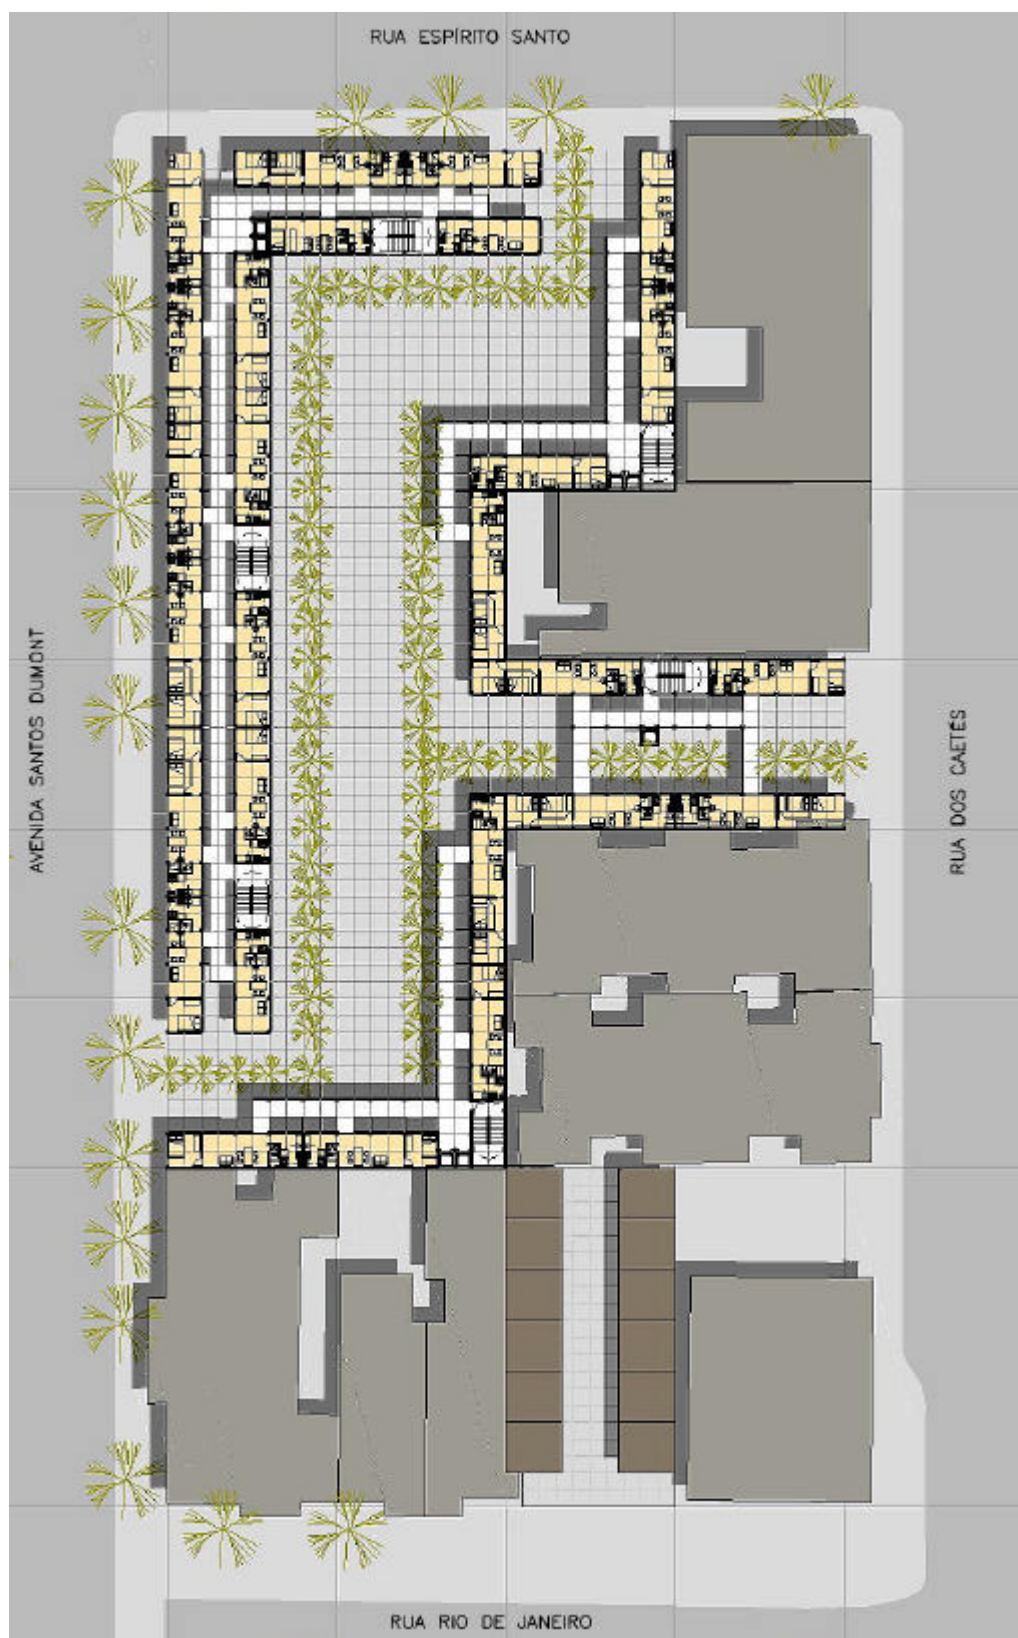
Planta pavimento tipo – Apartamentos.
